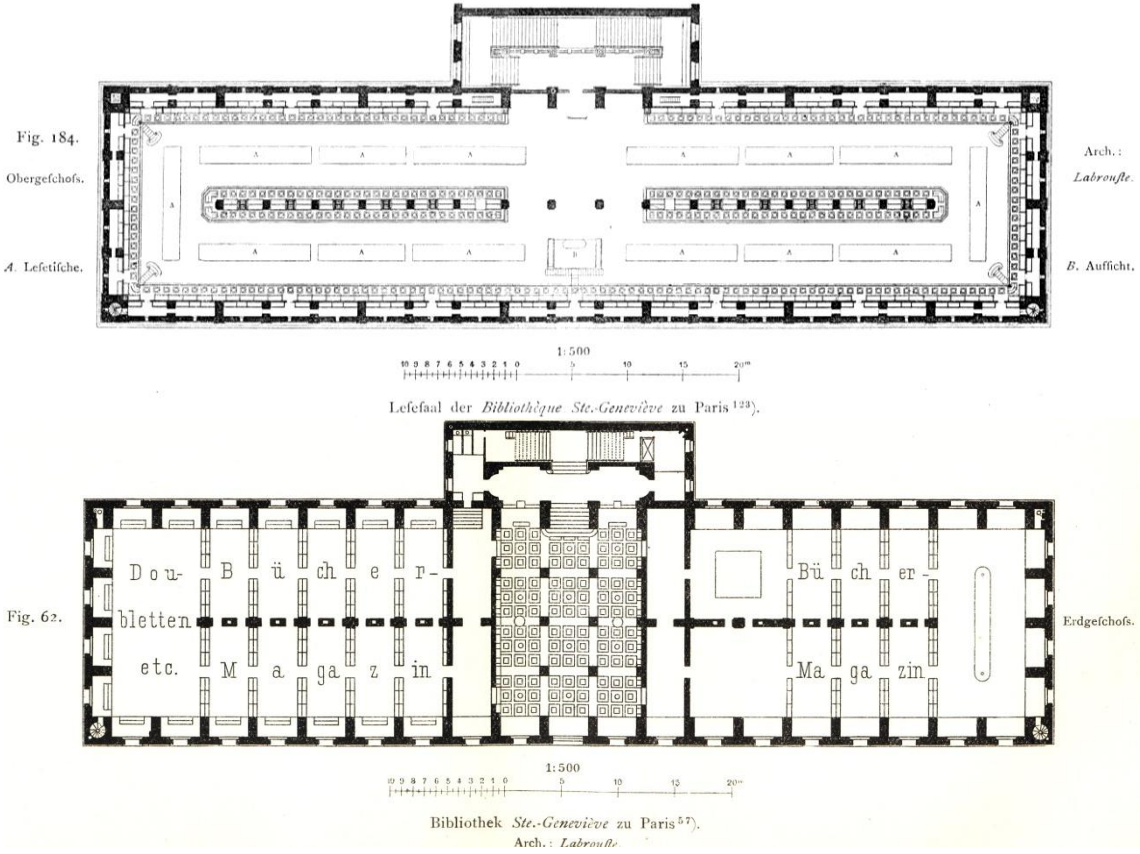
Plantas da Biblioteca Ste. Geneviève
